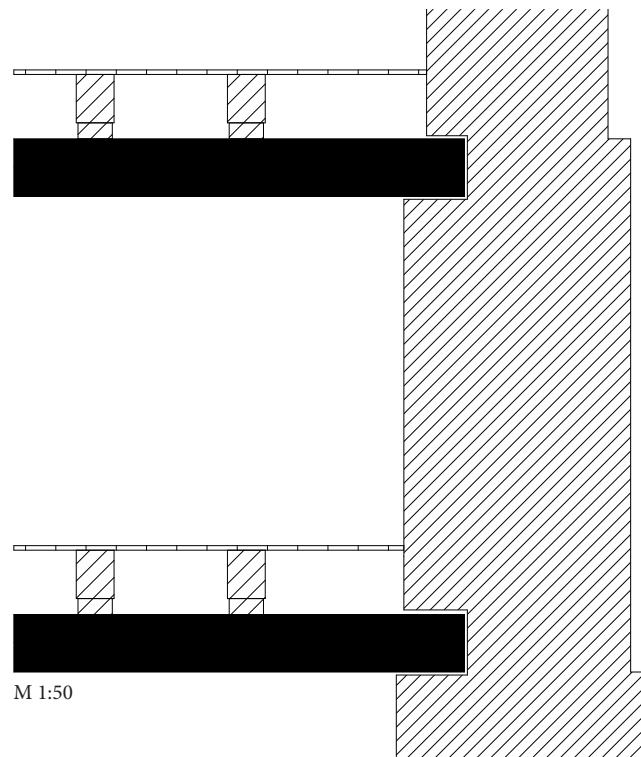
Knotenpunkt Mauerwerk Tramdecke
